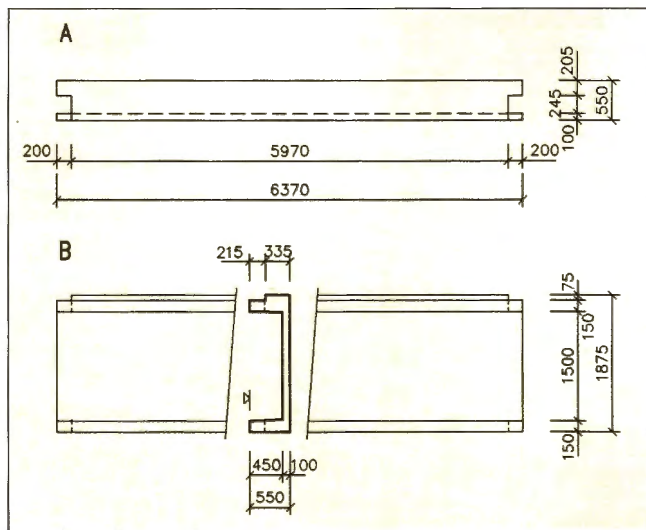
Obvodový balkónový panel, A – čelní pohled s řezem, B – půdorys / Balcony cladding panel, A – front view with cross-section, B – ground plan
